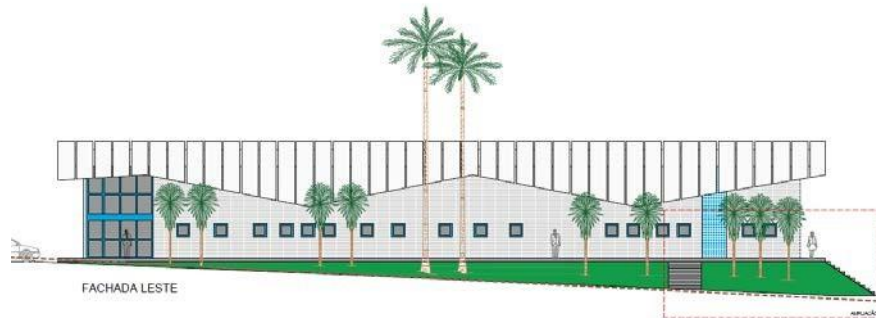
Croqui da fachada leste. (Fonte: Autores)
